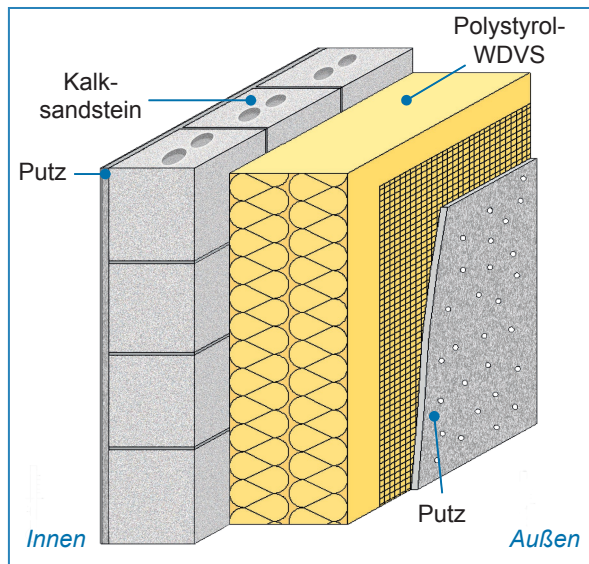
Wandaufbau Kalksandsteinkonstruktion
